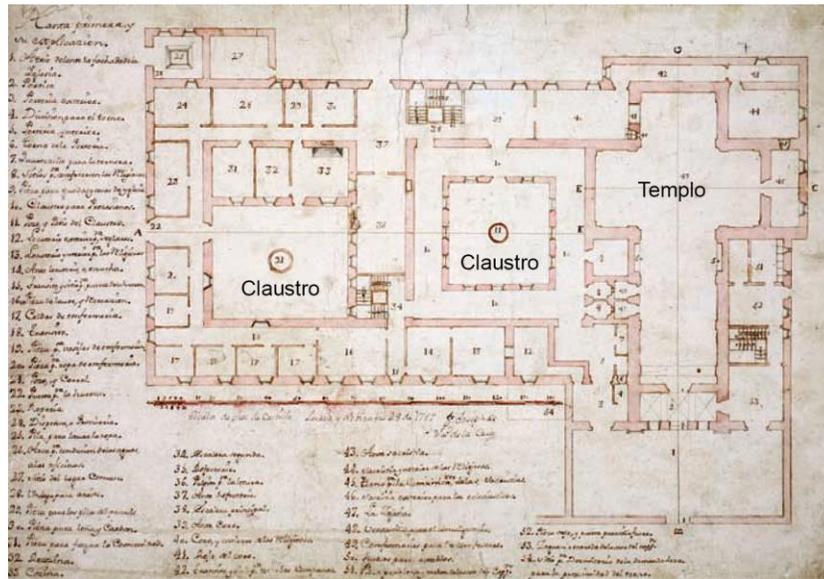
Planta del primer piso del Convento de Carmelitas Descalzas de Lesaca (Fray José de San Juan de la Cruz, 1767). Archivo de las Carmelitas de Lizaso. Fuente: "Arquitectura para un carisma" (Tarifa, 2016).
